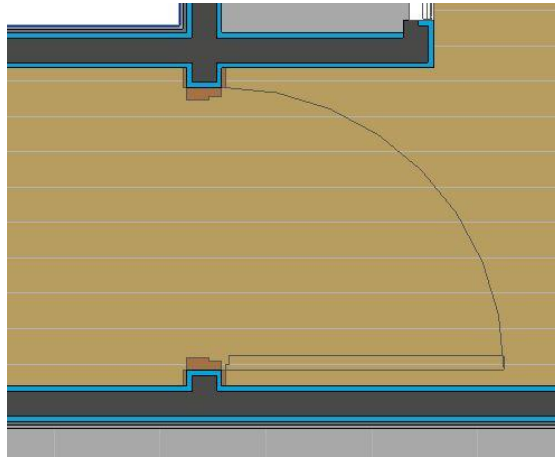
Detalle la puerta en Revit. Fuente: Elaboración Propia
